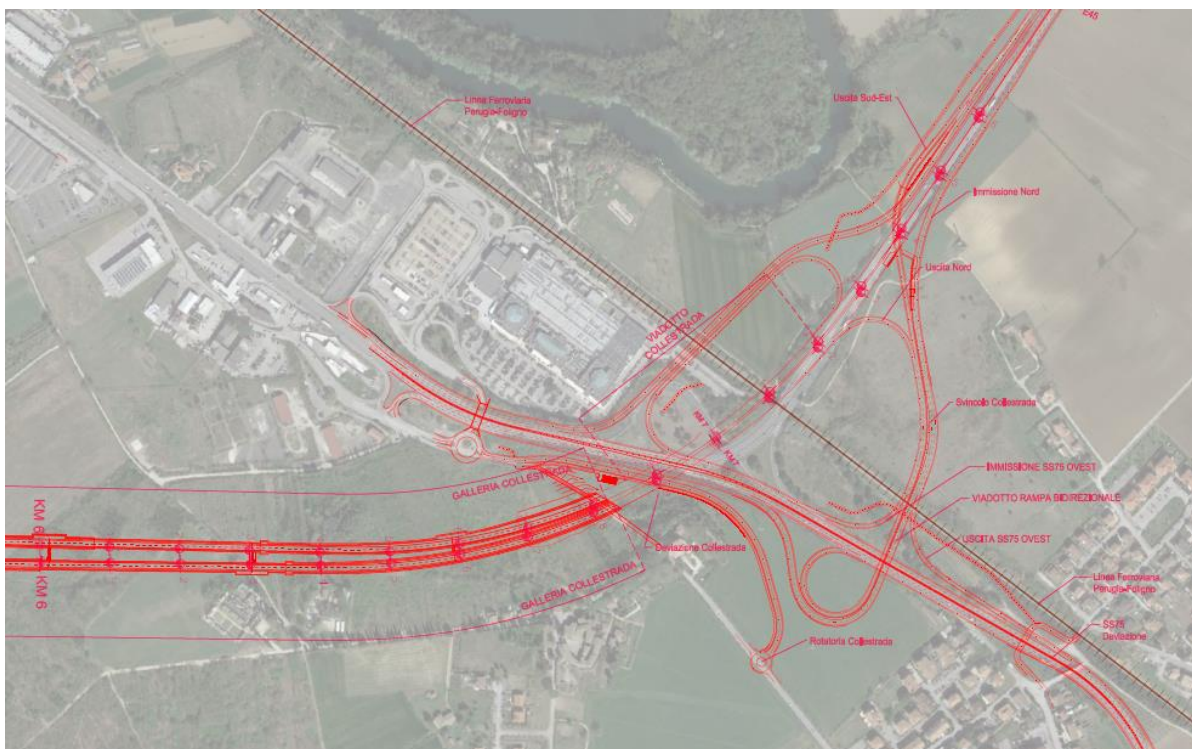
Svincolo di Collestrada – Progetto Definitivo 2023
